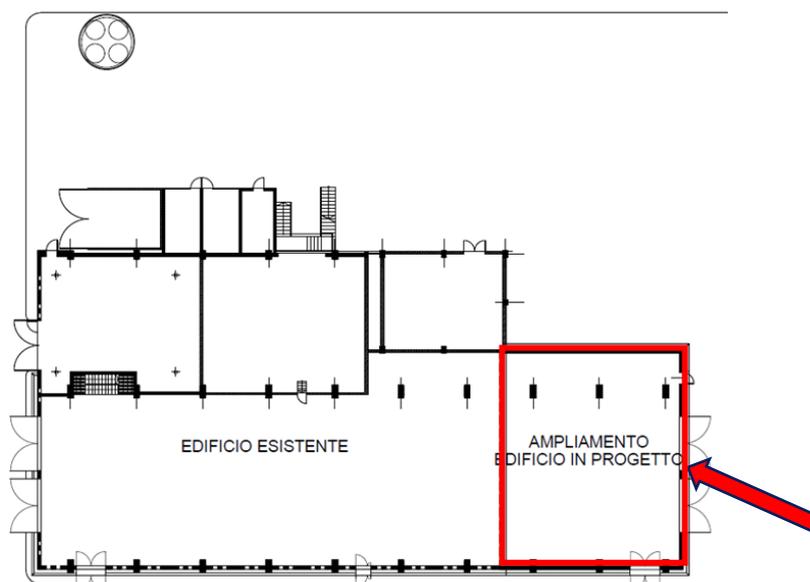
planimetria di progetto – area di ampliamento della centrale (perimetro in rosso)
